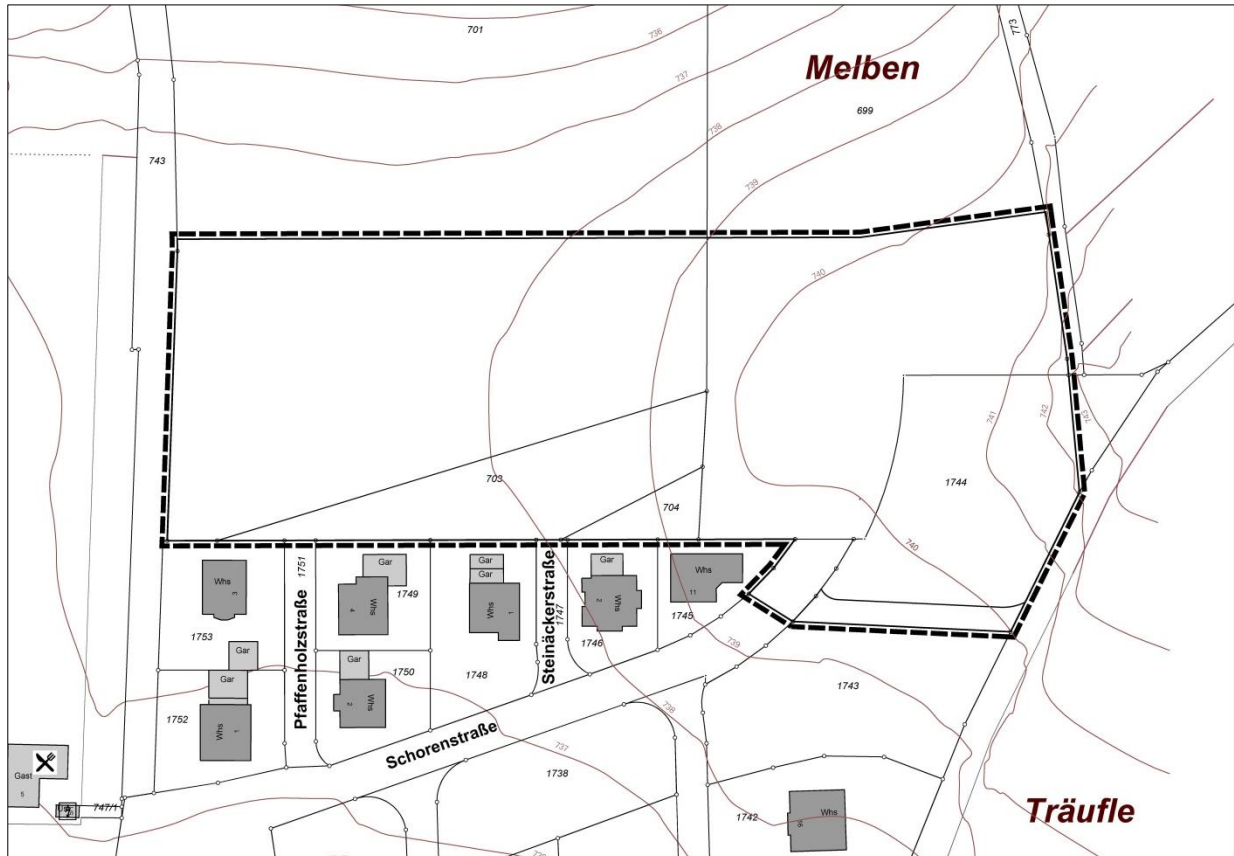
Geltungsbereich des Bebauungsplans 'Melben / Träufler-Hengst, Nord'
